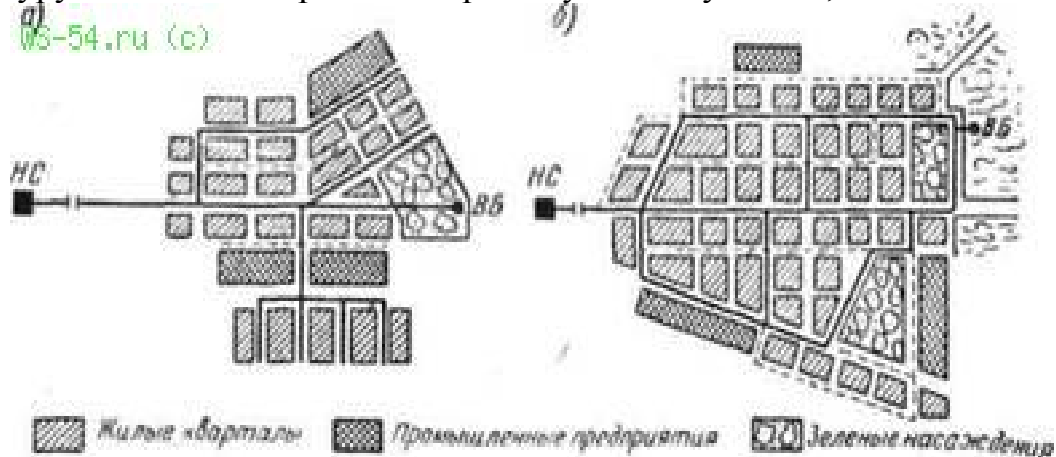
Водопровідна мережа: а - розгалужена; б - кільцева; НС - насосна станція; "ВБ" - водонапірна вежа
